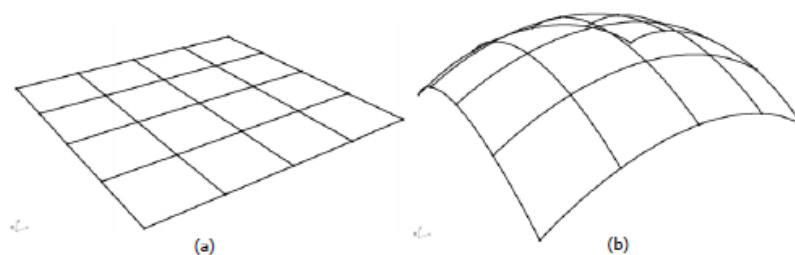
a) Grelha disposta no plano; b) Grelha deformada através da dobração de ripas (Toussaint, 2007)
